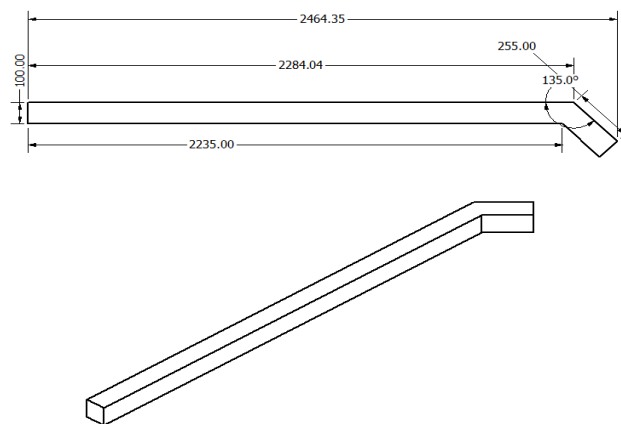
Dimensiones y vista en perspectiva isométrica del Poste de Hormigón Armado.
